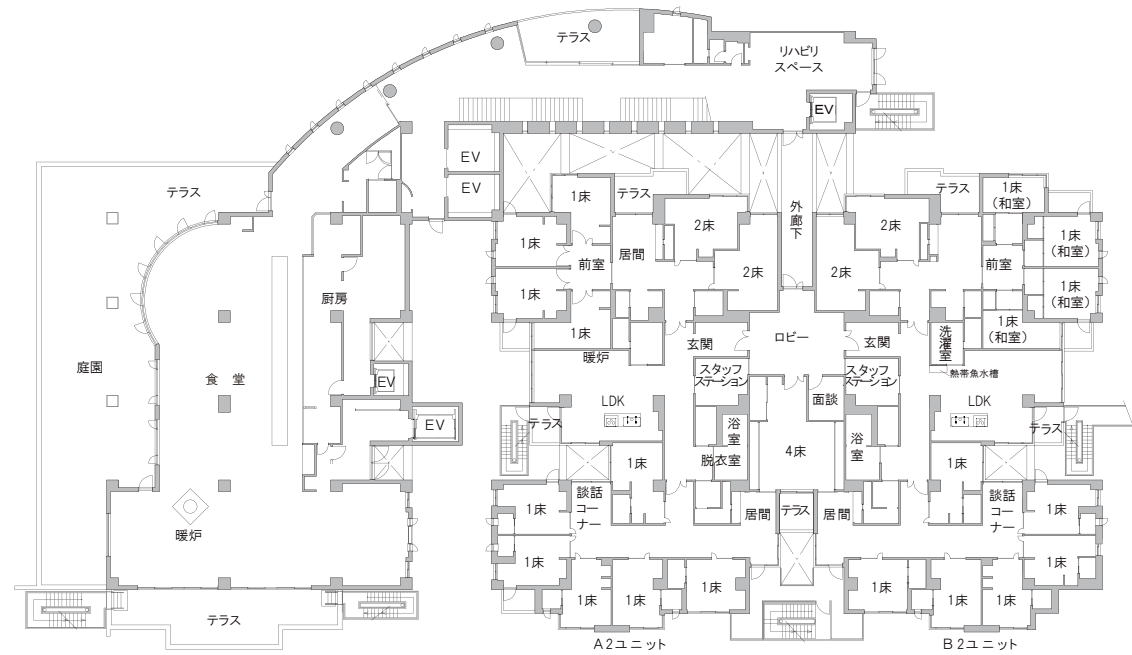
S 病棟の平面図 (2 階) 及び病室の例
